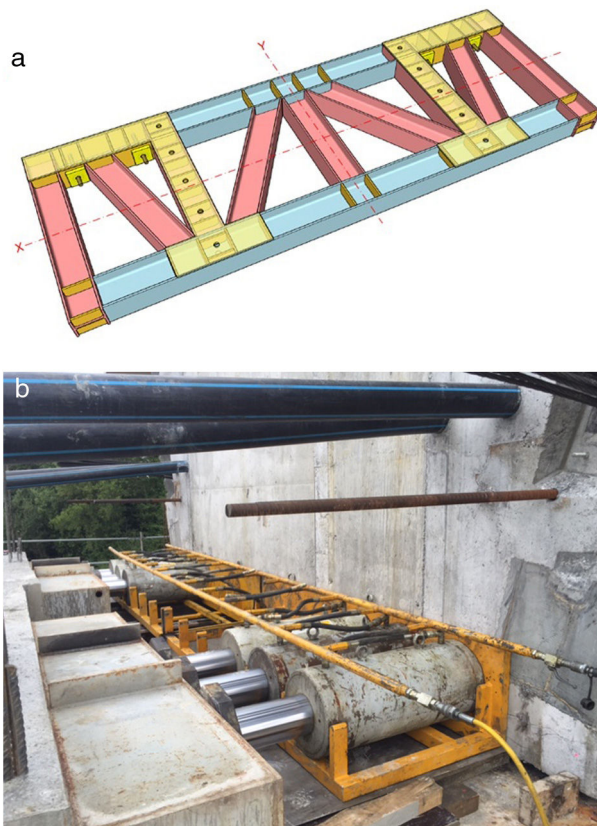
Viga de arrastre (arriba) y gatos de apoyo auxiliar sobre espaldón de estribo (abajo).
